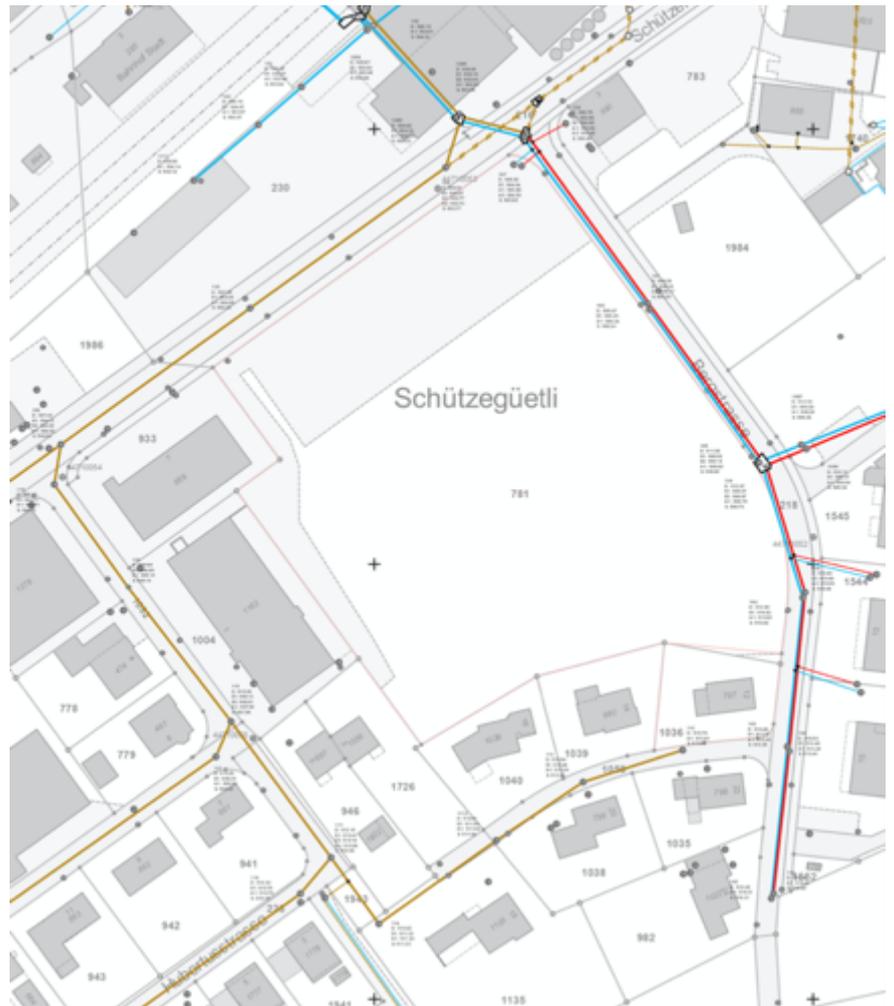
Werkleitungen EW, TV, Wasser (ohne Massstab)
